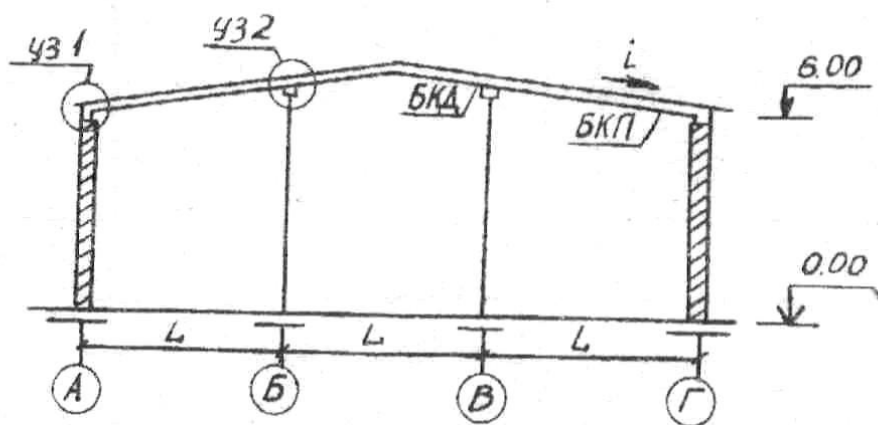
Общий вид и поперечный разрез деревянной балки покрытия
